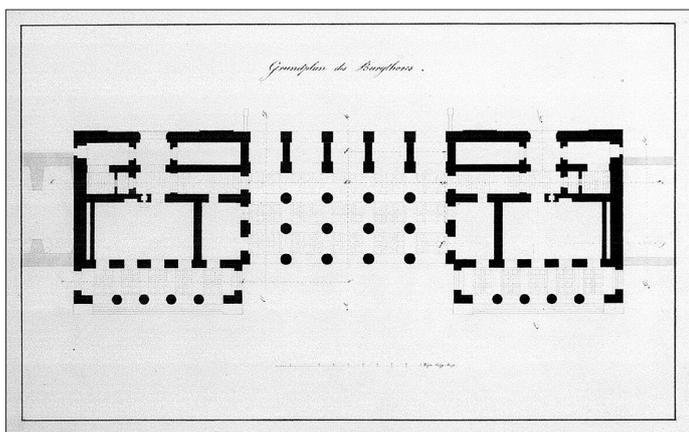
, Äußeres Burgtor nach Pietro Nobile 1824, Grundriss, Albertina Wien
